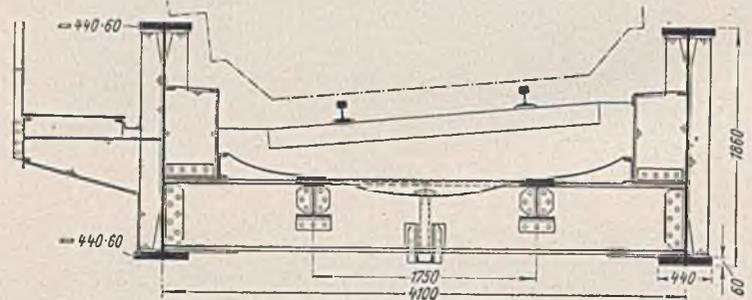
Querschnitt der Eisenbahnbrücke bei Farchant
